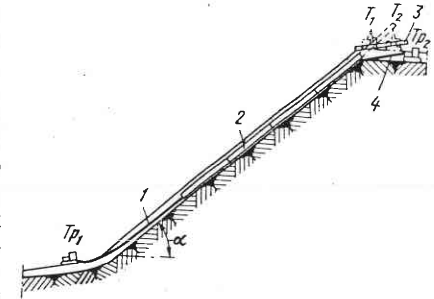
Схема монтажа трубопровода сверху вниз:
